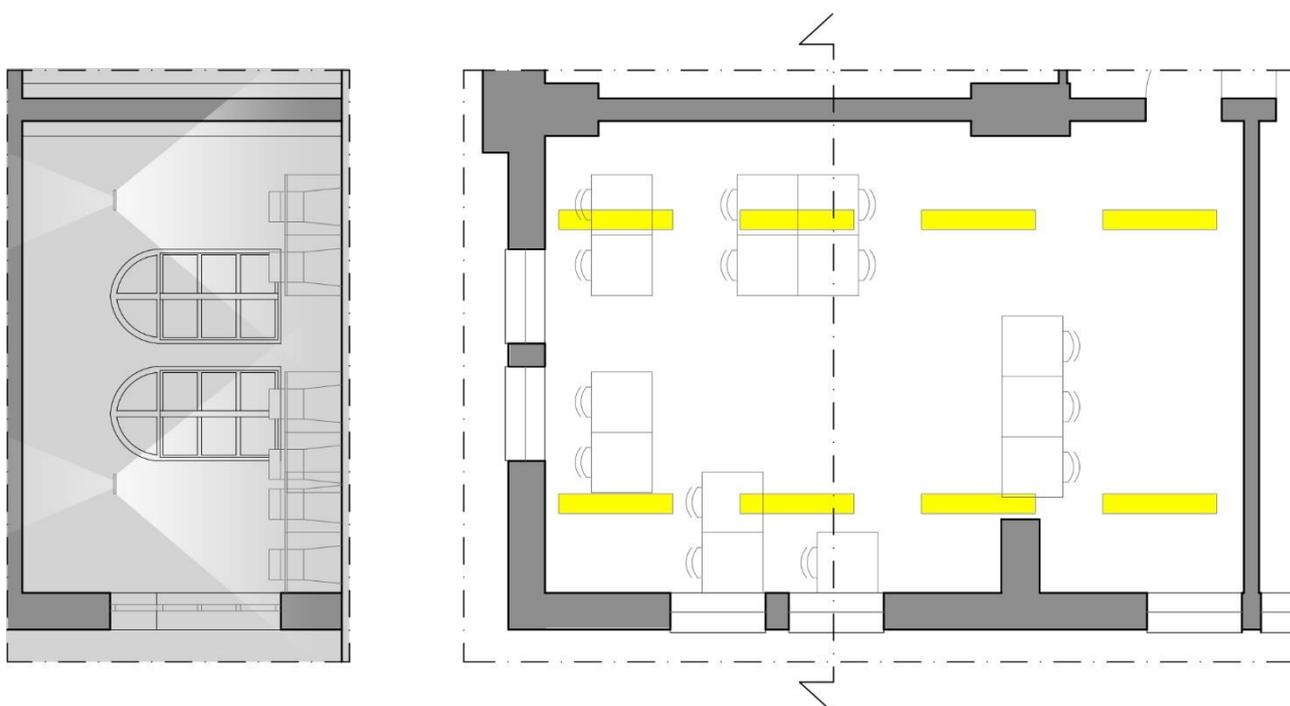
Pianta e sezione fuori scala del laboratorio tipologia 1 con disposizione dei banchi e degli apparecchi.
